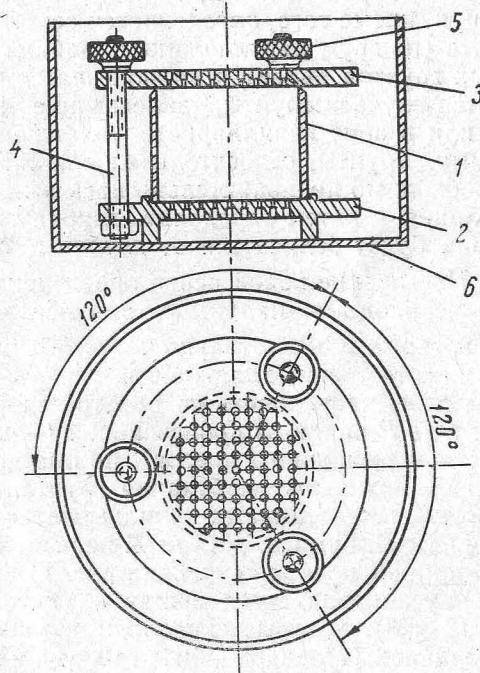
Прибор для насыщения грунта водой без возможности его набухания.
